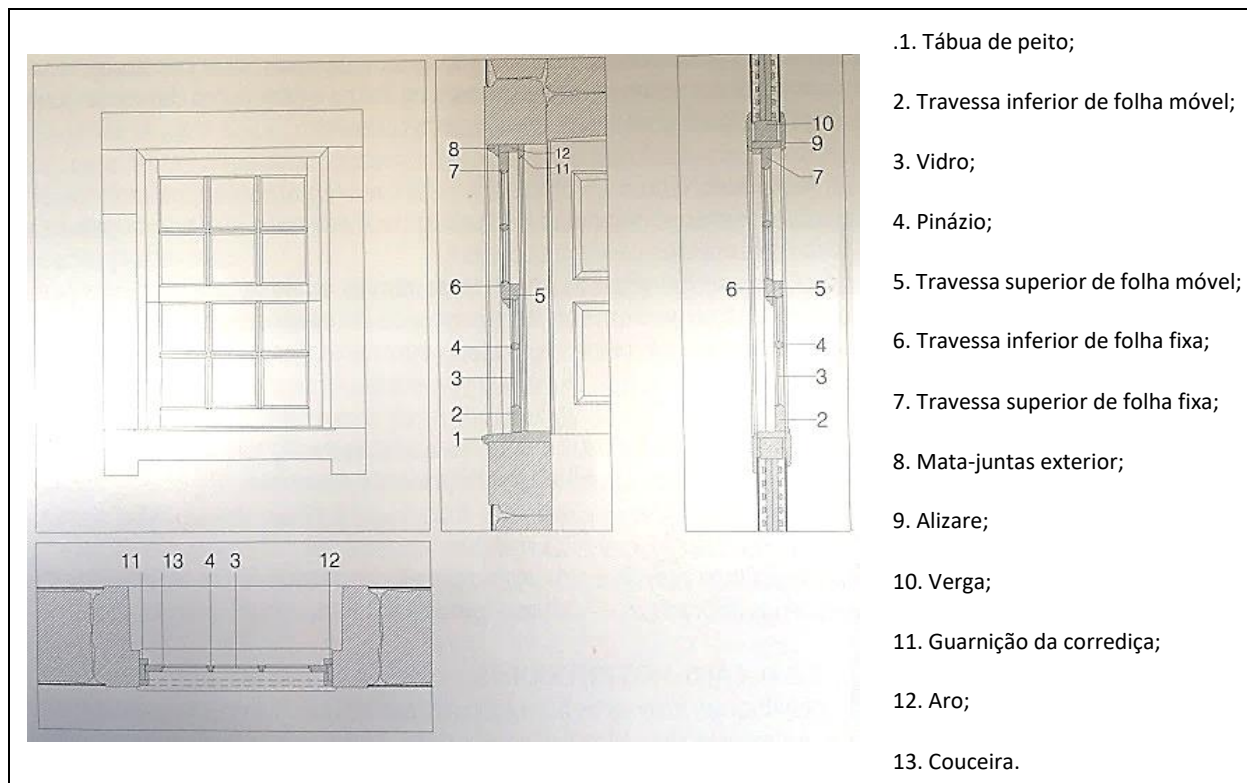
À esquerda, alçado e corte de janela de guilhotina em parede de alvenaria. À direita, corte de janela de guilhotina em parede de tabique [1]
